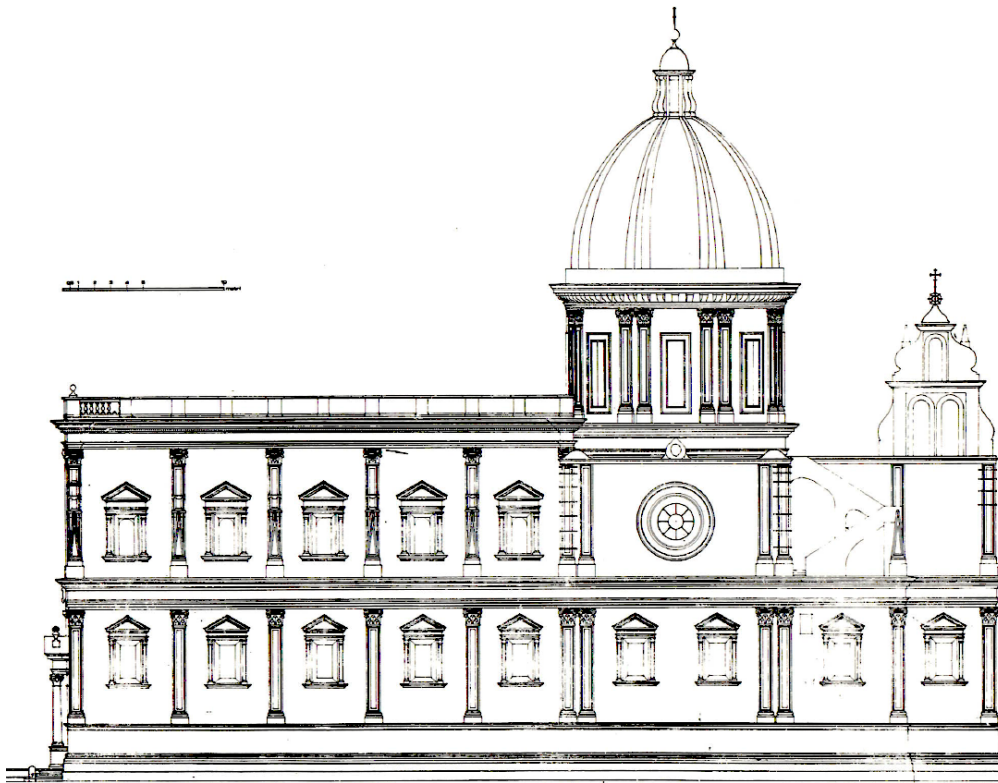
Prospetto della Chiesa su piazza De Nicola (da Petreschi)
